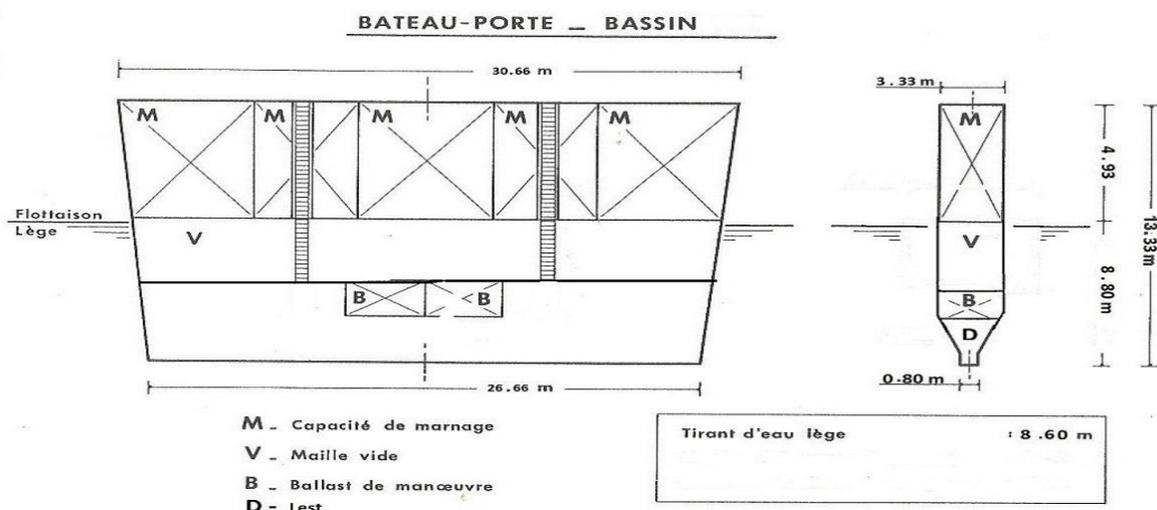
Coupe longitudinale et coupe transversale d'un bateau porte (Dessin Joseph Tonard - Alain Cloarec)
